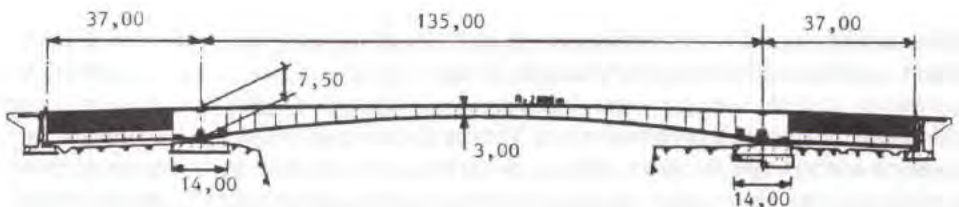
Coupe longitudinale du pont sur la Rivière de l'Est.
